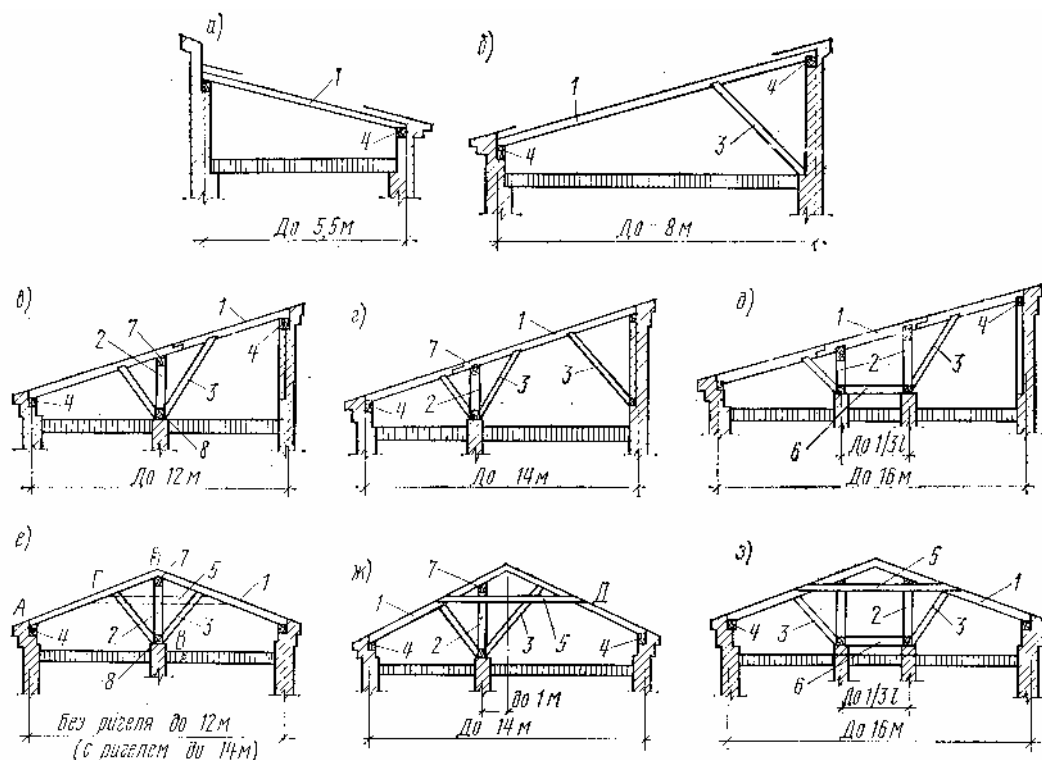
Конструктивные схемы деревянных наслонных стропил:
